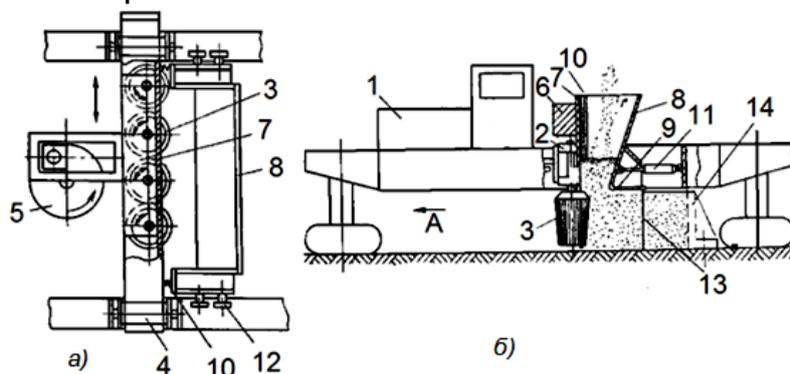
Устройство для уплотнения грунта: вид сверху (а) и вид сбоку (б), стрелка А - направление рабочего движения: 1 - самоходное шасси; 2 - несущая балка; 3 - вертикальные ролики; 4 - направляющие; 5 - привод; 6 - рама; 7 - передняя часть; 8 - задняя часть; 9 - скользящая опалубка; 10 - кожух; 11 - гидроцилиндр управления; 12 - опорные ролики; 13 - основание автодороги; 14 - вспомогательный упор
